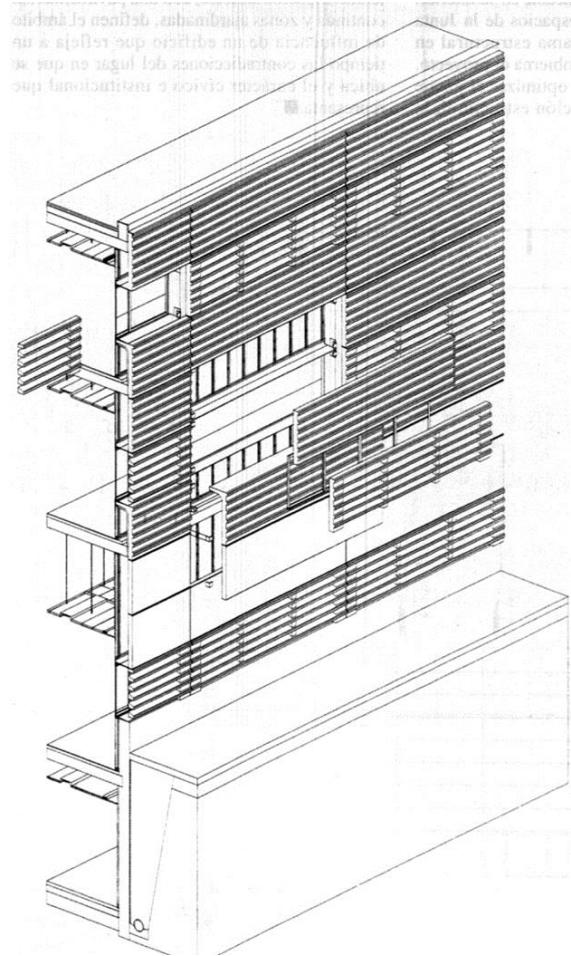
(arriba derecha) Fachada con tratamiento de paneles prefabricados de hormigón lisos, estriados o en celosía.
